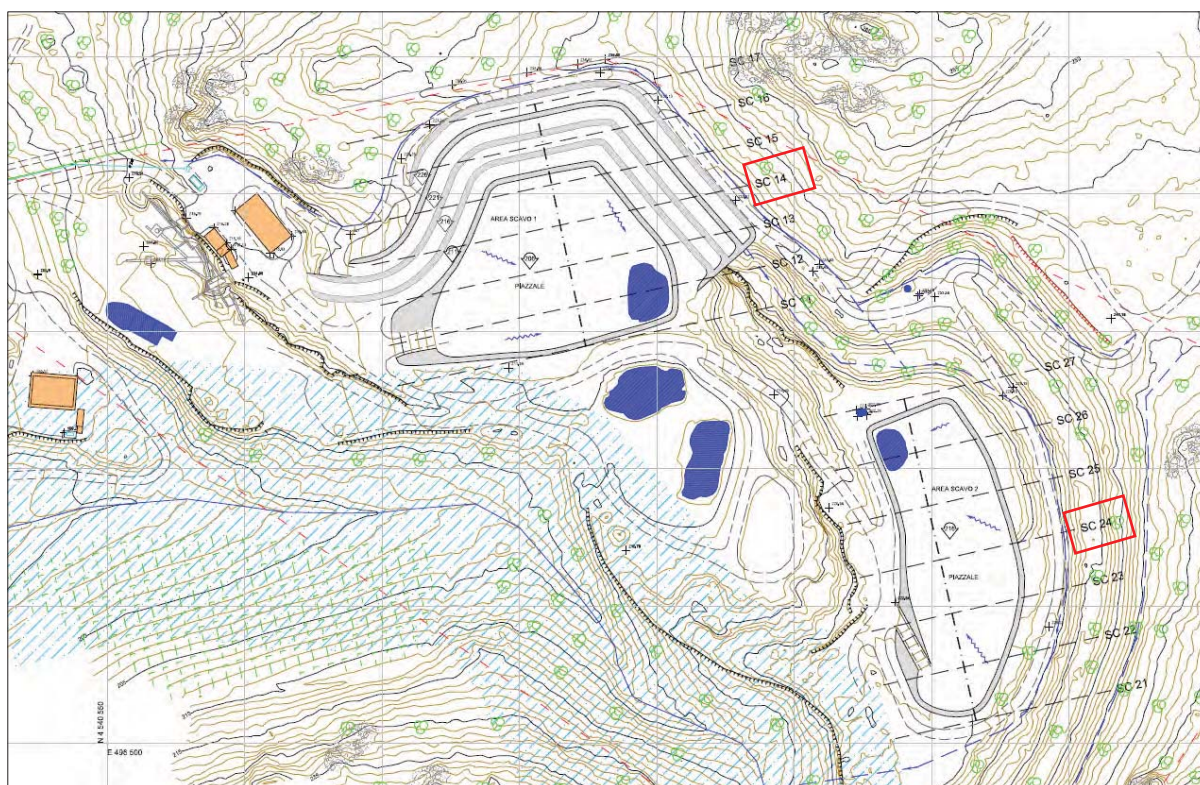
/A – Planimetria del sito allo stato finale di coltivazione (Tav. P.6)
